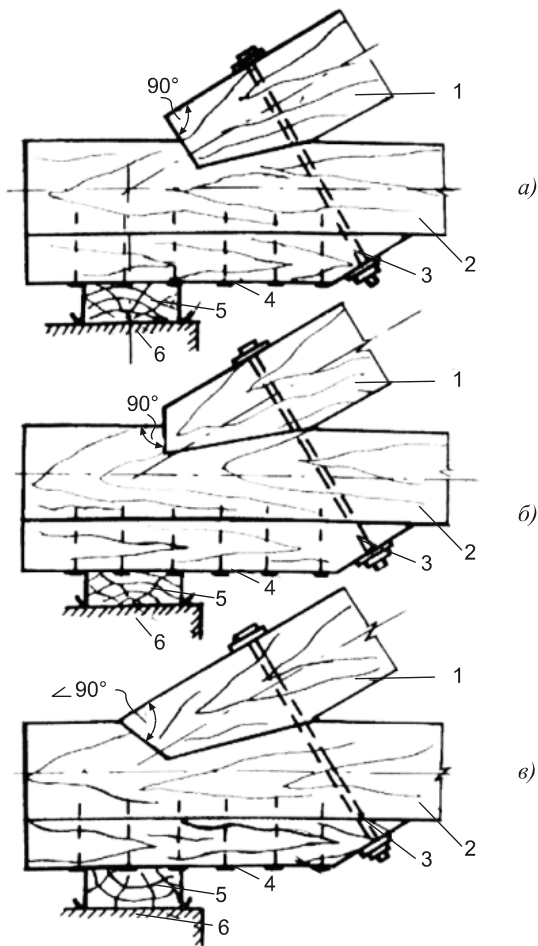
Правильное (а) и неправильное (б, в) выполнение узлов соединения деревянных элементов в лобовых врубках: 1 — сжатый элемент; 2 — растянутый элемент; 3 — стяжной болт; 4 — подбабка; 5 — подкладка; 6 — толь
